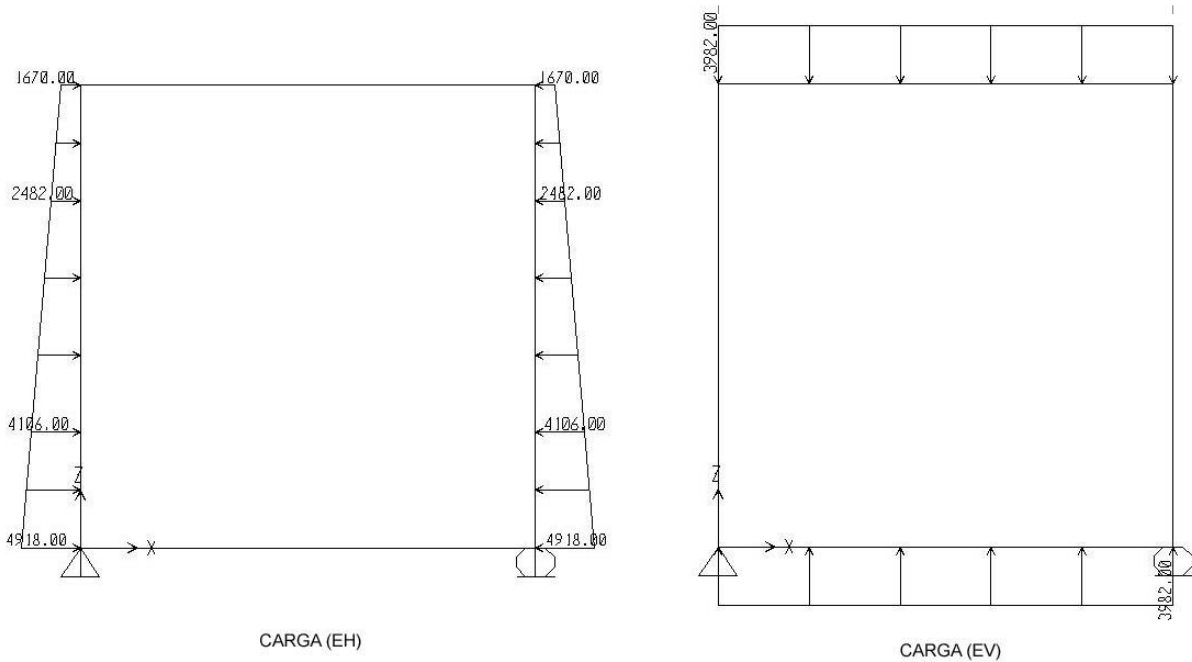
Cargas EH y EV aplicadas en la alcantarilla
